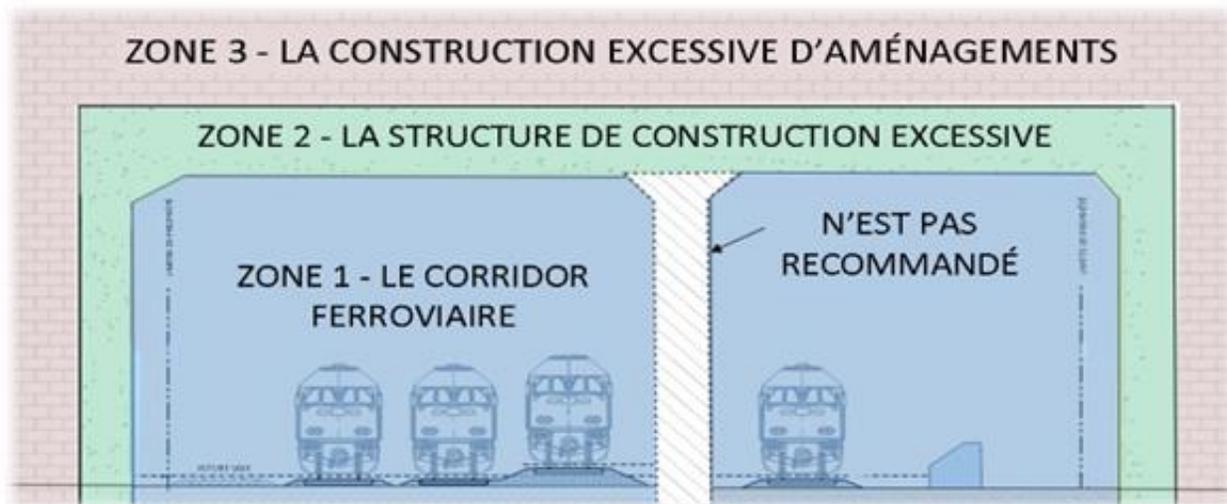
Développement conceptuel de la construction excessive d'aménagements, corridor ferroviaire affecté et zones 1, 2, 3
